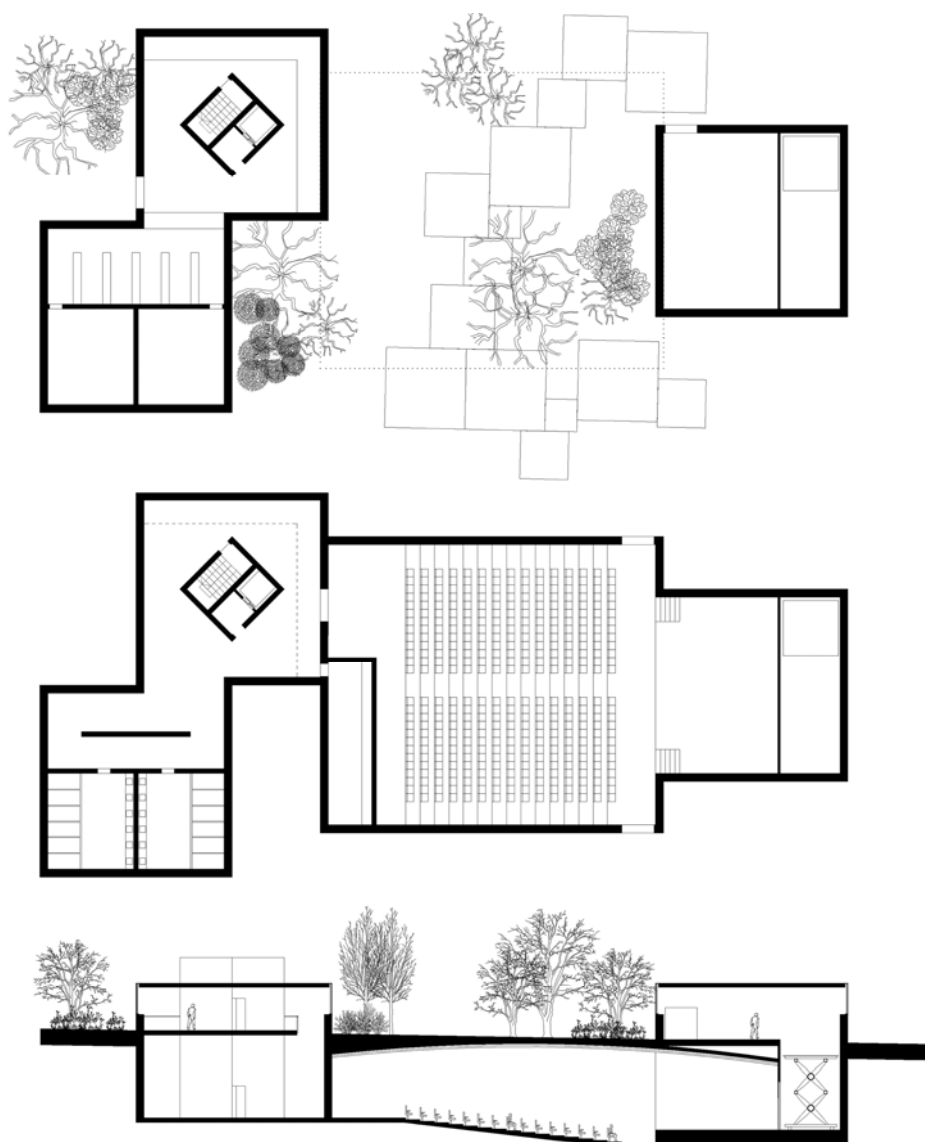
Plantas e corte do Auditório (ilustração nossa, 2012)
